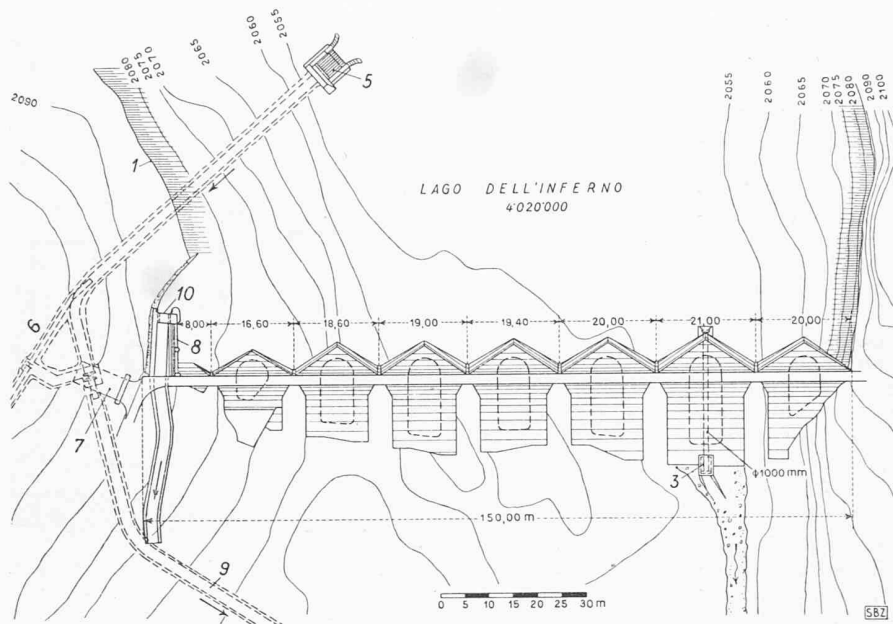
Stausee Inferno am Bitto, Lageplan der Pfeilerstaumauer, Masstab 1:1500
